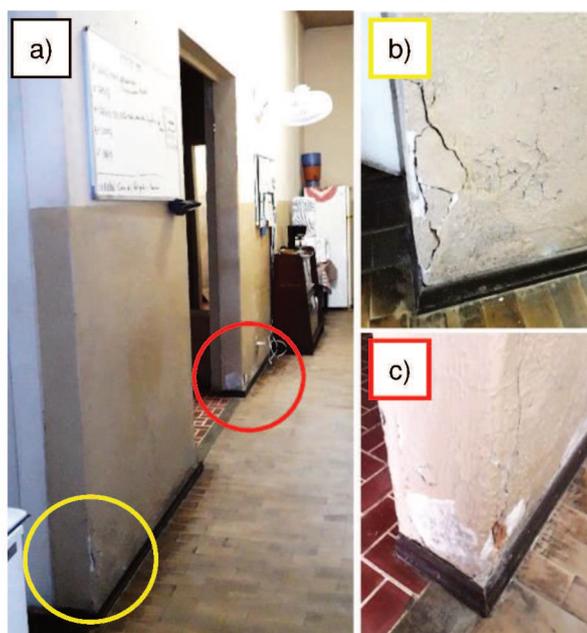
Parede fachada sul: (a) manifestação de vesícula; (b) descolamento com empolamento
